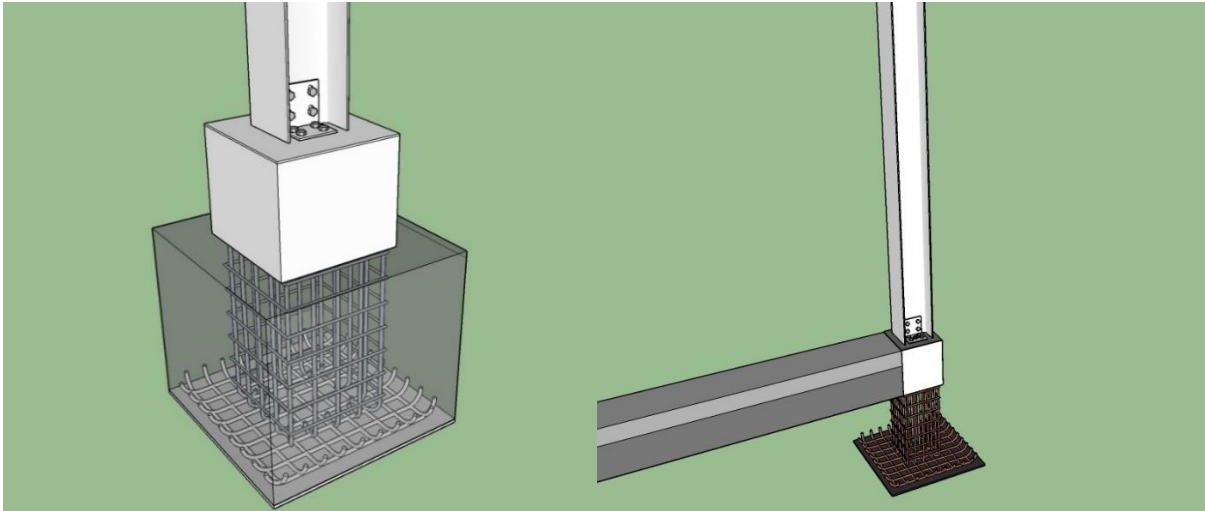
Détail de fixation d'un profilé HEA sur une semelle.
